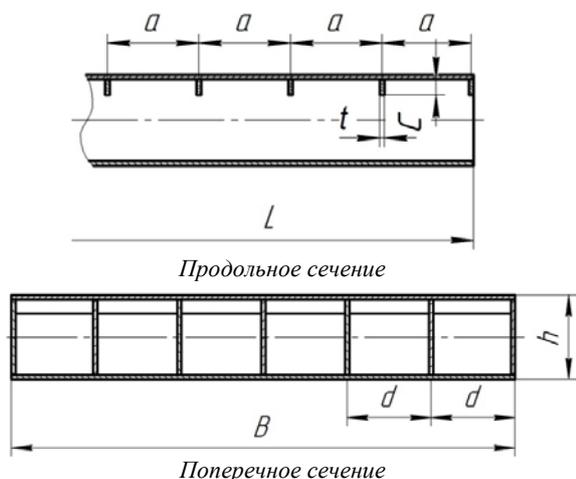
Коробчатая конструкция с поперечными ребрами, подкрепляющими верхний сжатый пояс: a – шаг подкрепляющих ребер, s – высота ребра, t – толщина ребра
